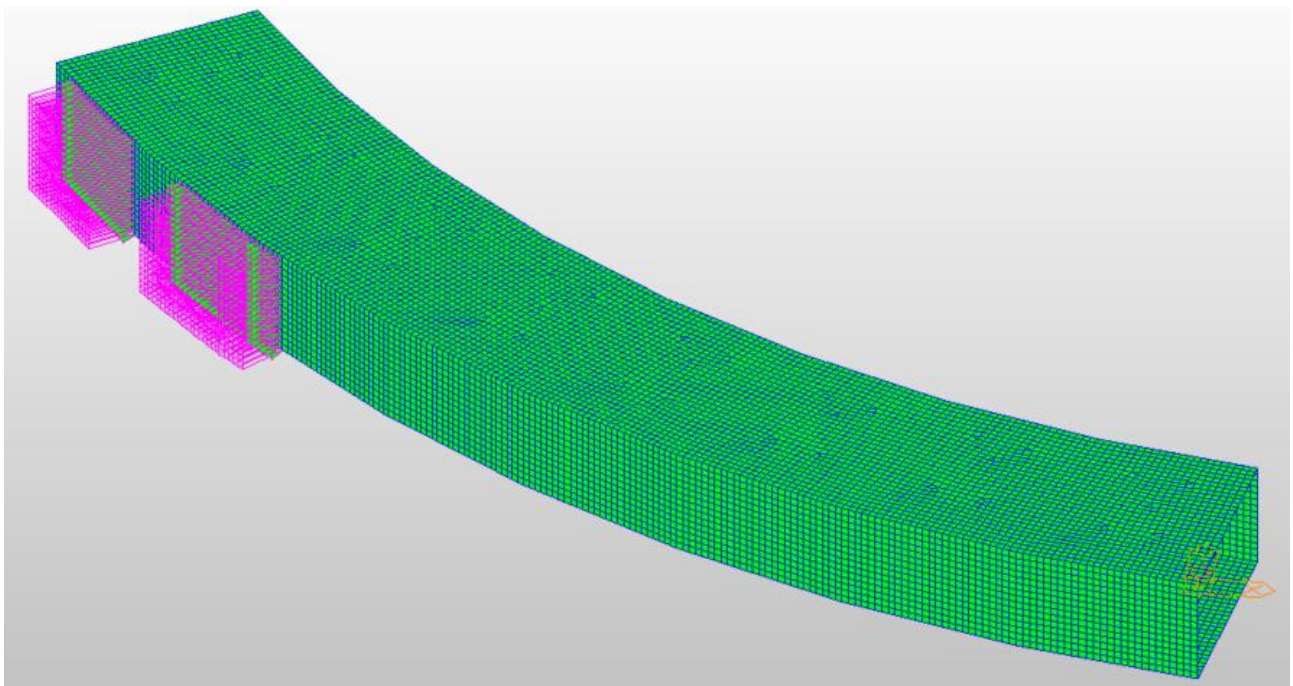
Distribuzione delle pressioni sulla parete dello scatolare dovute ai carichi da traffico di tipo TS disposti sul rilevato a tergo dello scatolare.
